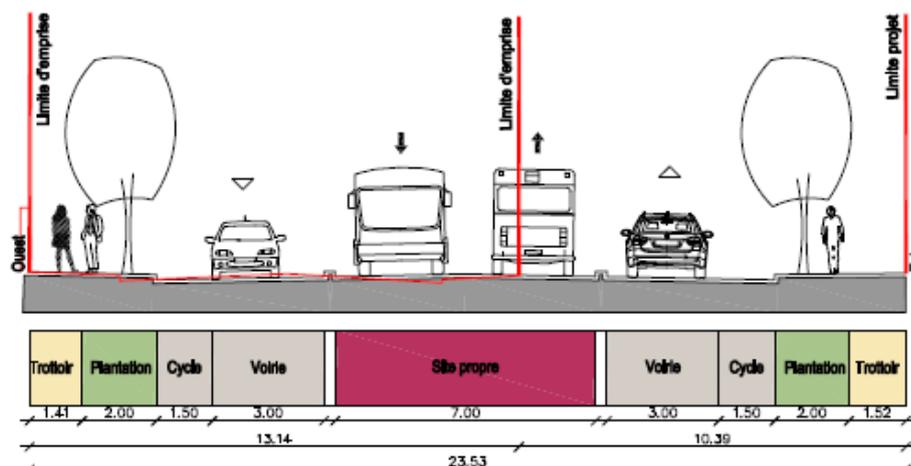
coupe projetée sur la RD392 entre le franchissement des voies ferrées et le Boulevard Schuman
